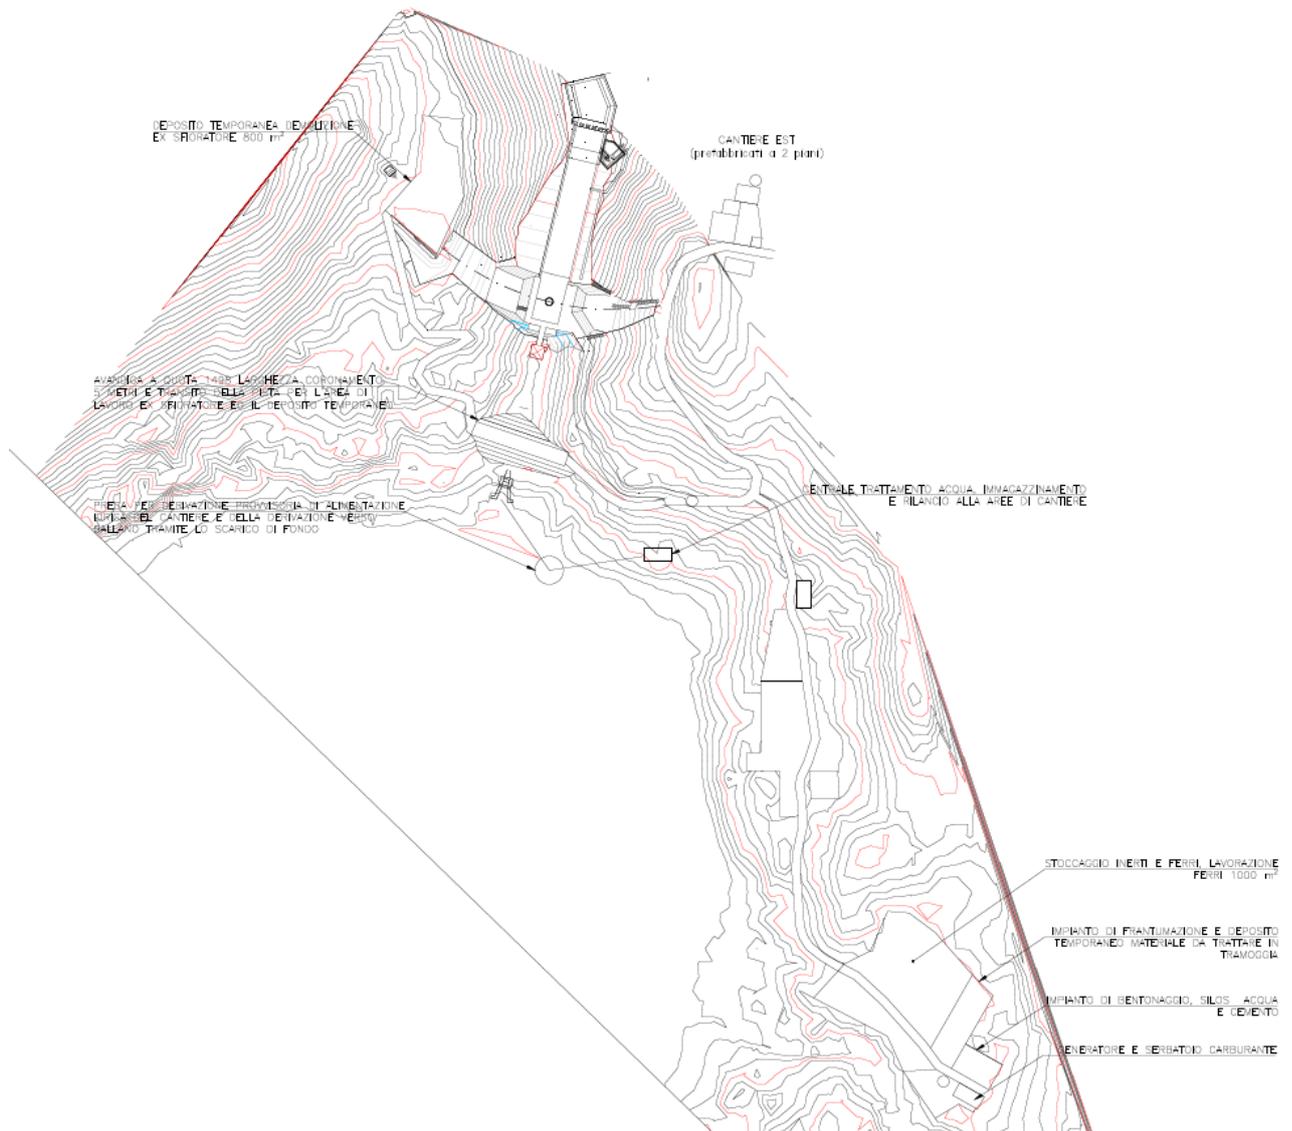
Inquadramento generale aree di cantiere e di lavoro
